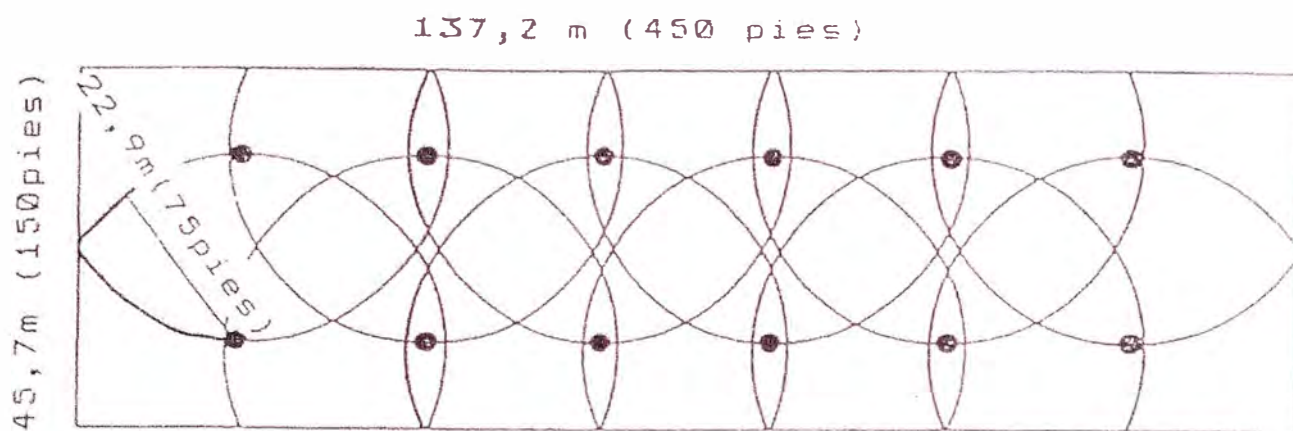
Requerimientos de distancia de recorrido y distribución de extintores instalados en columnas del edificio o paredes interiores
